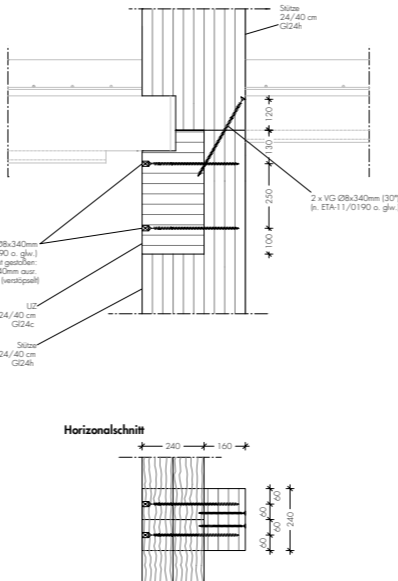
Anschluss Kragträger VD1an S301/S201 - E3/E2
